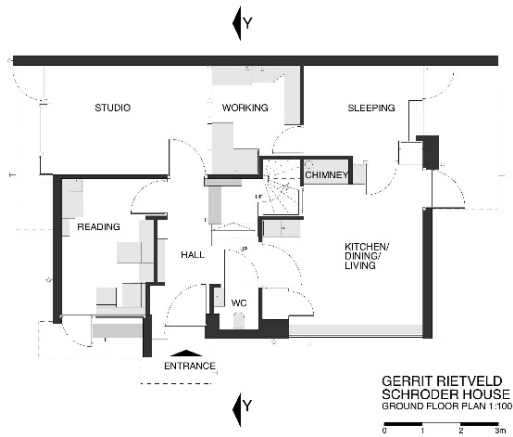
PLANTA ATUAL DO PISO TÉRREO CASA SCHRÖDER
